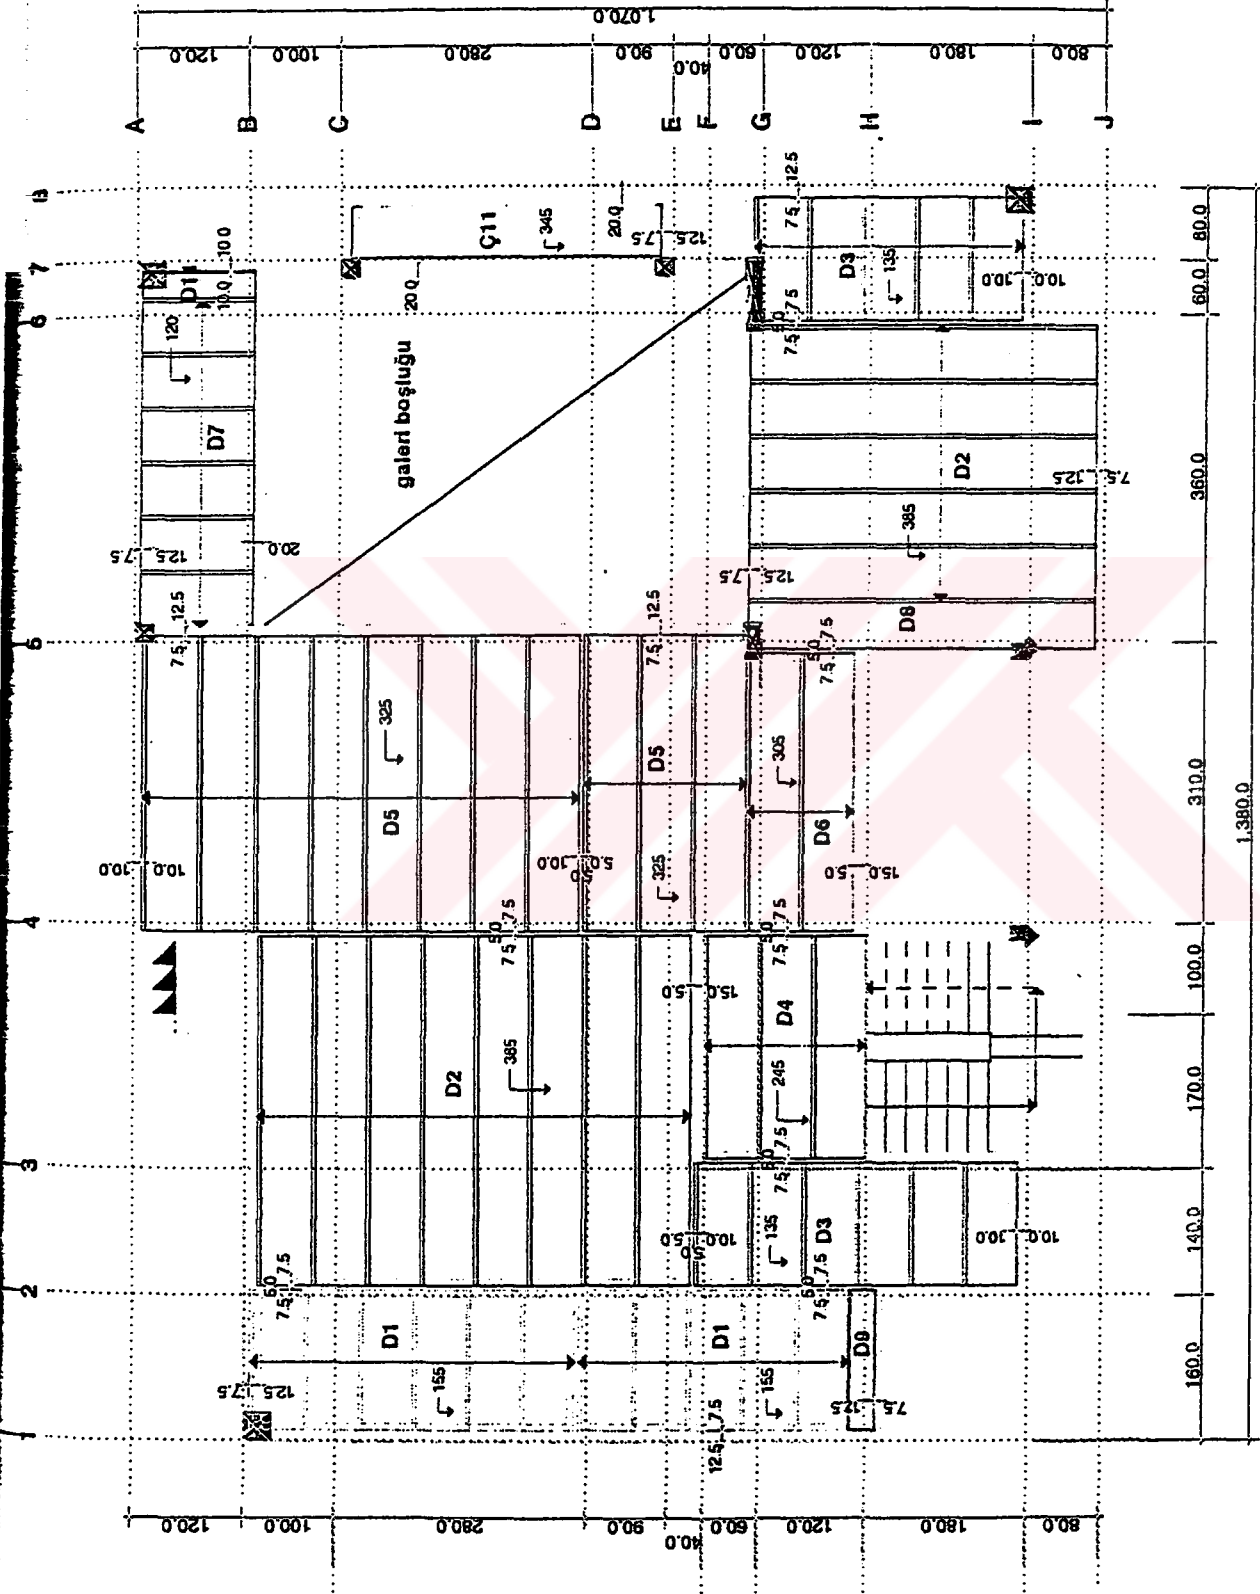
Çatı Katı Planı (Dönüşümden önceki proje)
